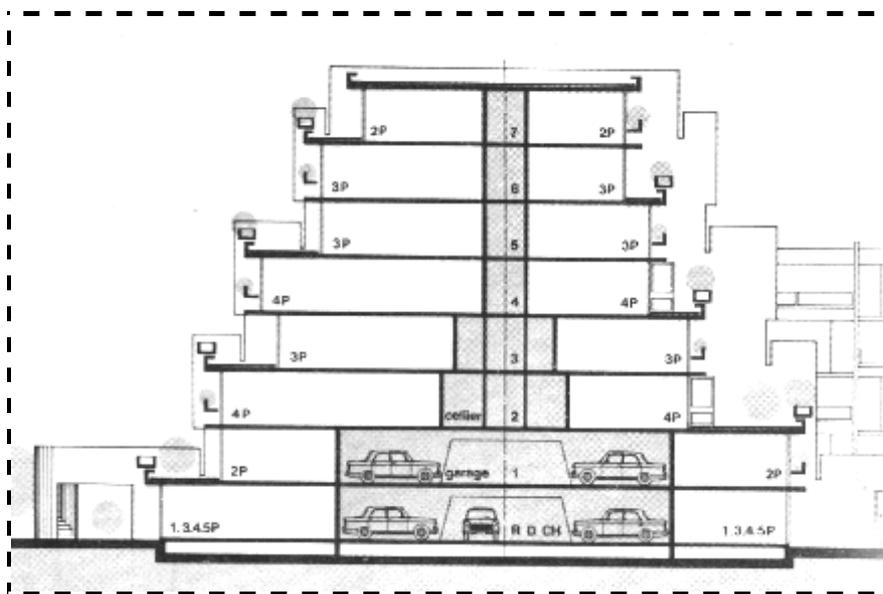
coupe théorique montrant la situation des garages souterrains
